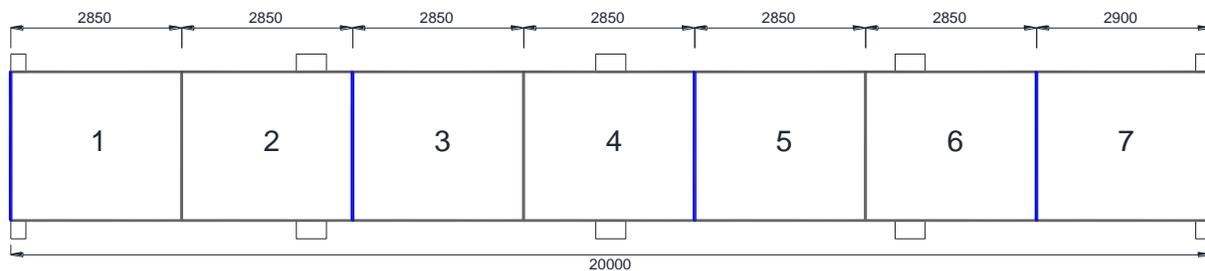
Juntas de expansión en piso de convección. Fuente: Planos del proyecto.
